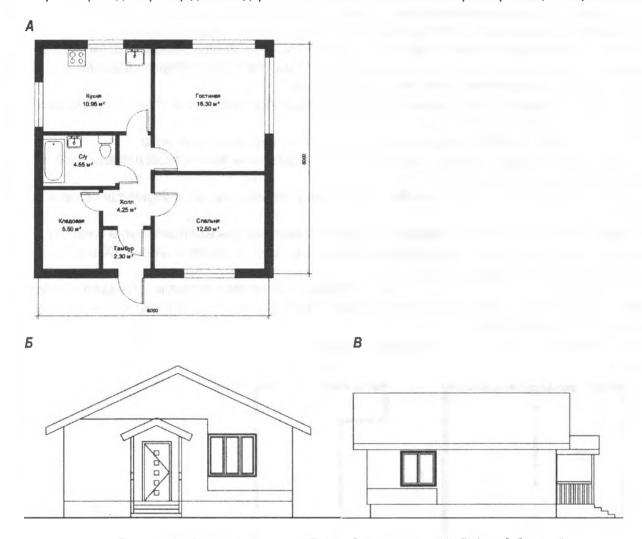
А-план 1-го этажа; Б-фасад фронтальный; В-фасад боковой
